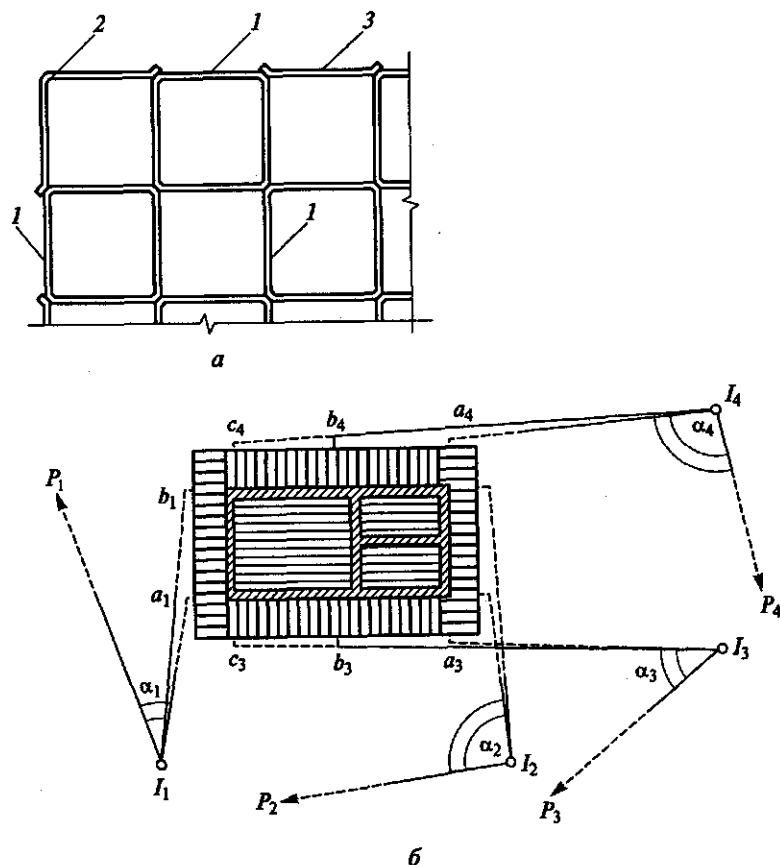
Монтаж элеваторов с силосами квадратной формы (план): а — взаимное расположение элементов; б — геодезический контроль при возведении стен; 1 — объемные элементы (СОГ); 2 — угловые элементы (СУГ); 3 — плоские элементы (СПГ)
